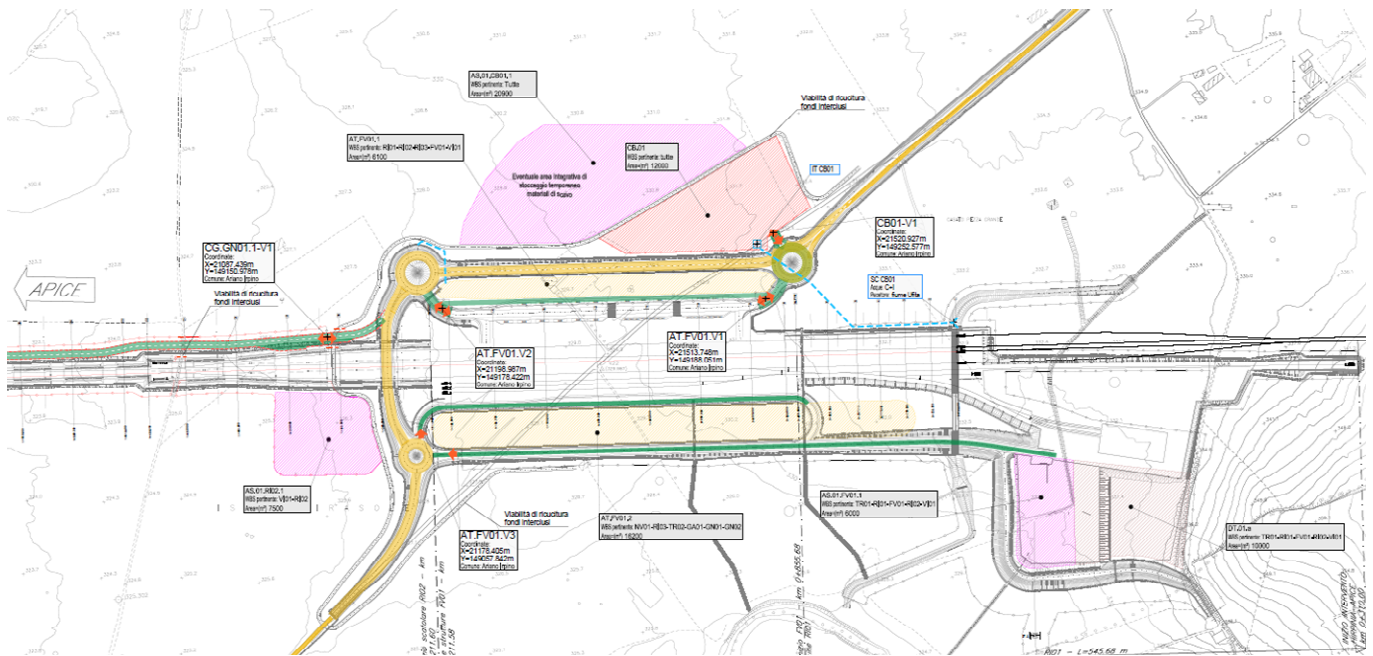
Area Grottaminarda: Cantiere Base CB.01 - Area DT.01.a, aree tecniche e aree stoccaggio.
